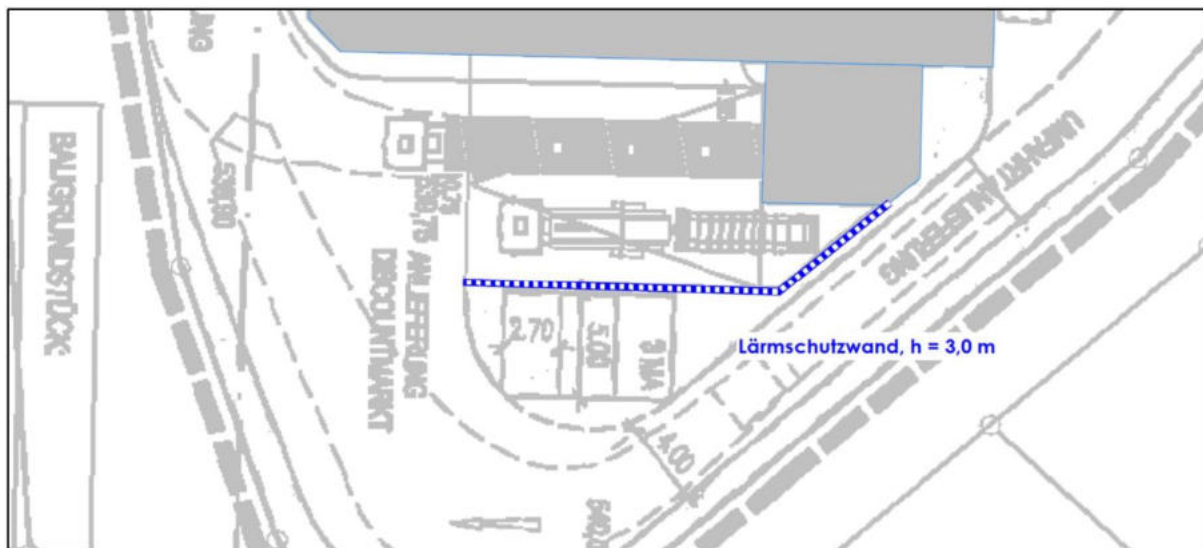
Lageplan mit Eintragung der Lärmschutzwand
